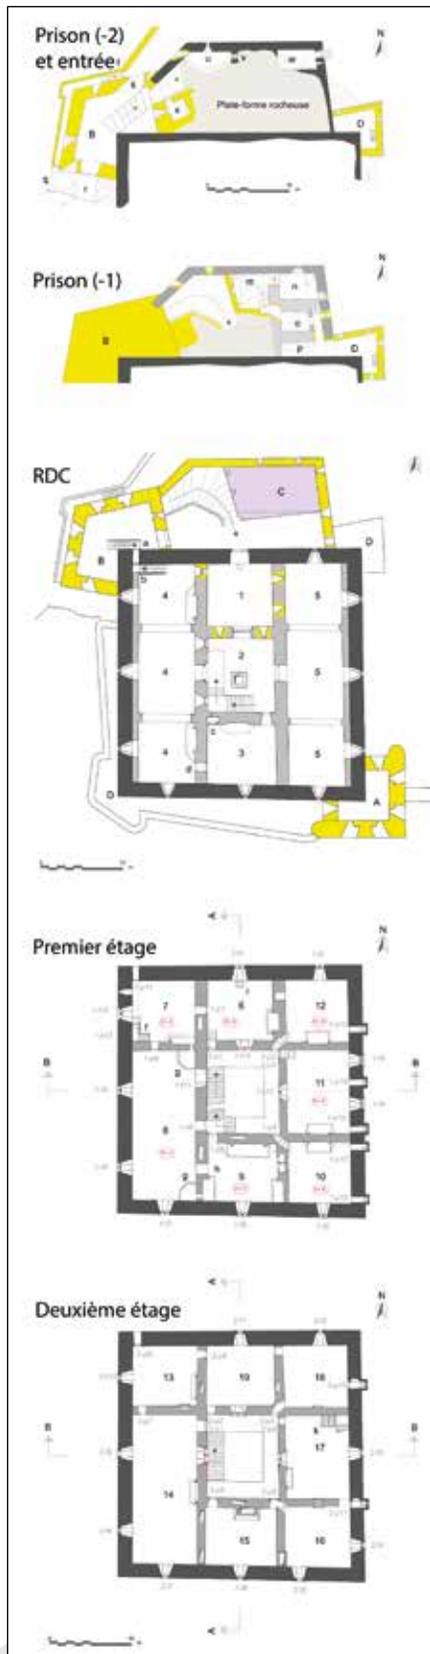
Verrès, plans du château par niveaux. En jaune, les constructions du XVI^e siècle (J. Mesqui).
